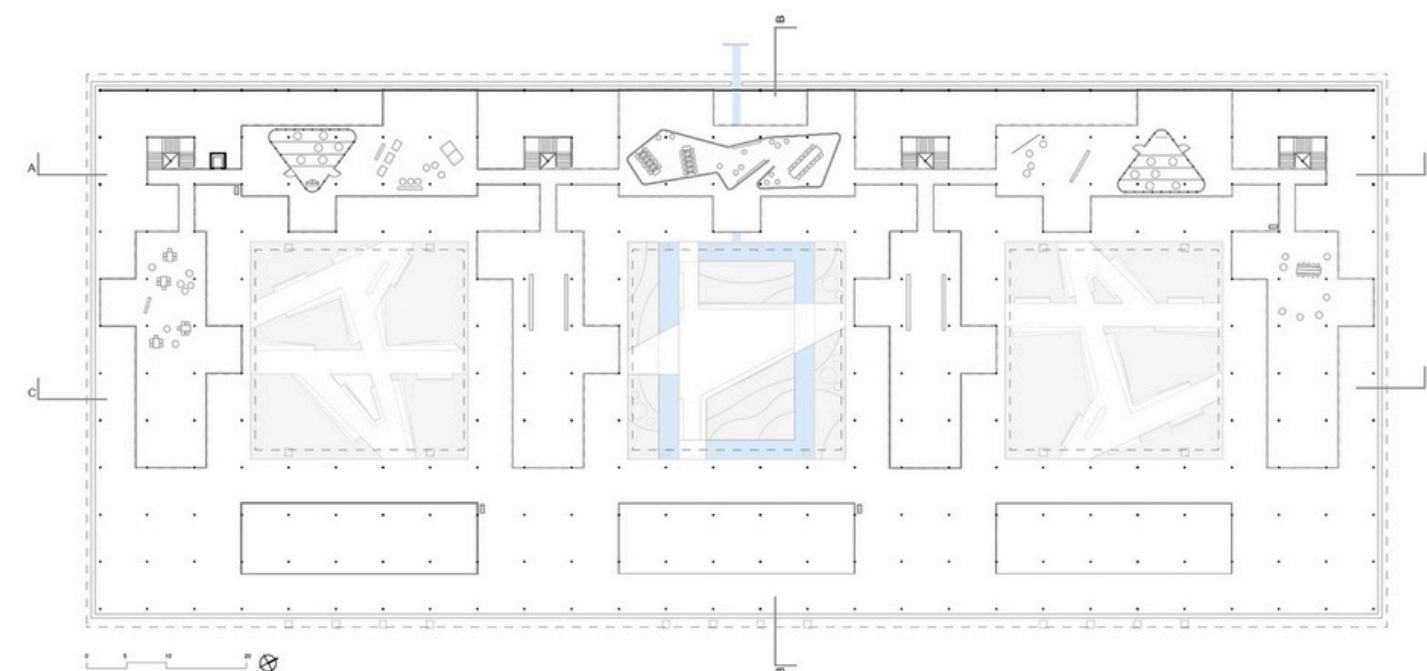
Planta Baixa do Pavimento Superior das Moradias.
